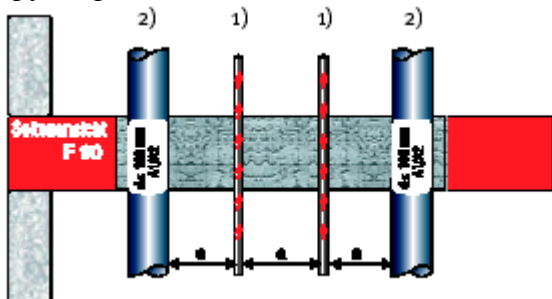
Отдельные трубопроводы без изоляции в общем отверстии для нескольких трубопроводов
